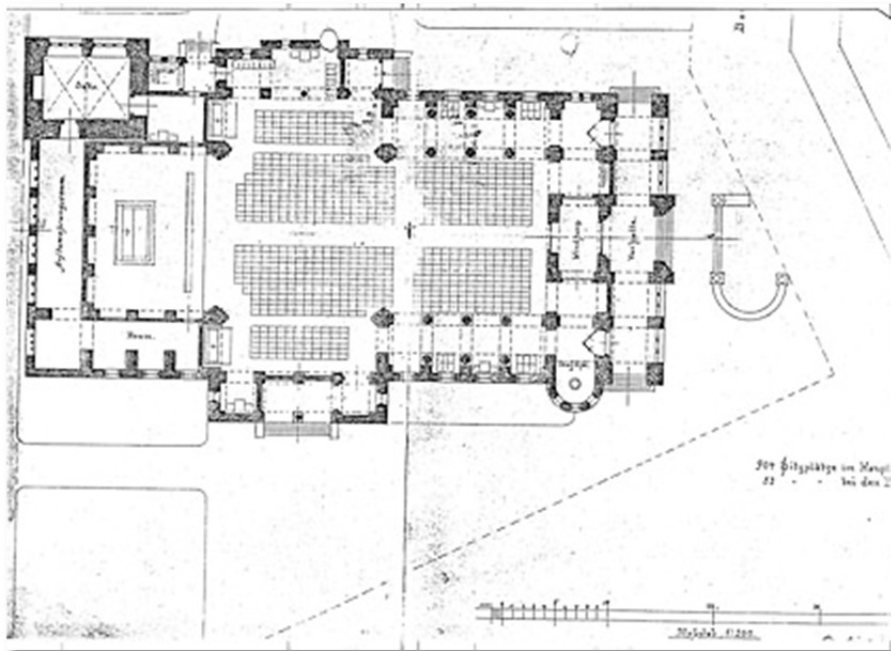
Grundrissdarstellung der St. Josephs Kirche in Osnabrück
